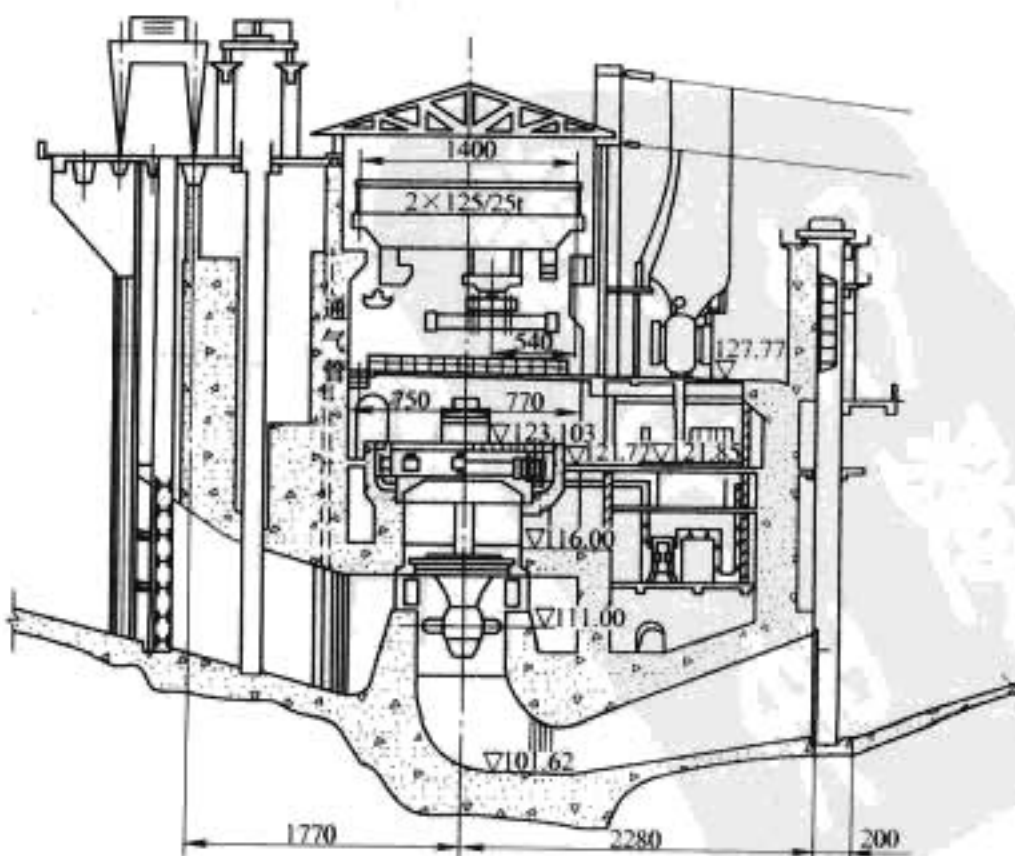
河床式厂房变压器布置在尾水平台的剖面图
